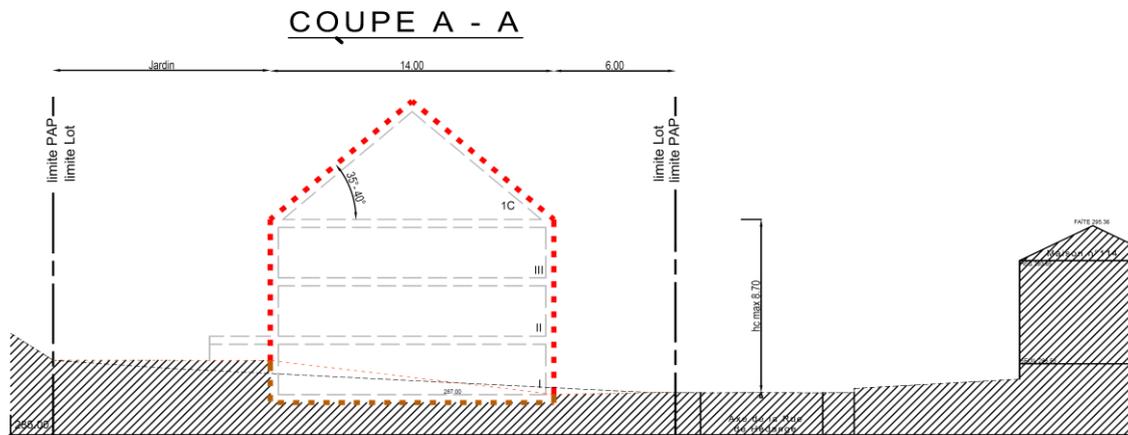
Coupe transversale des bâtiments (Source : BEST)
